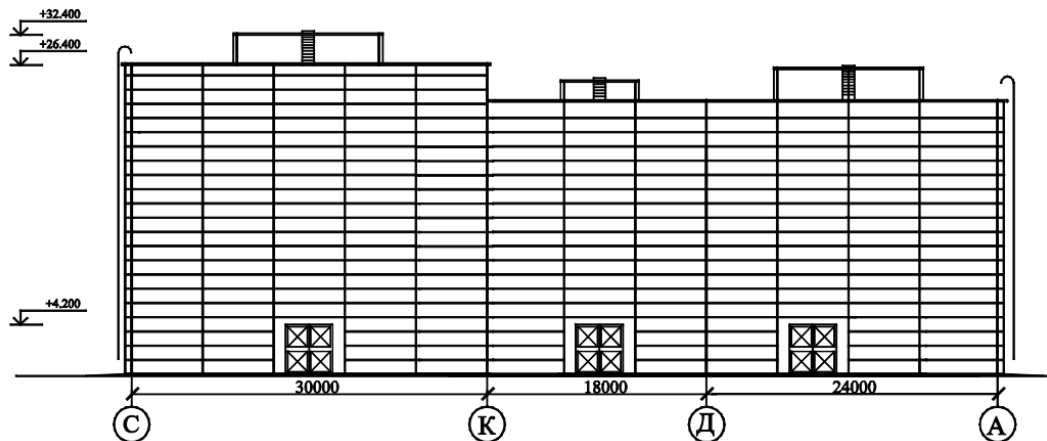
Схема розташування конструкцій огорожі фасаду С-А
